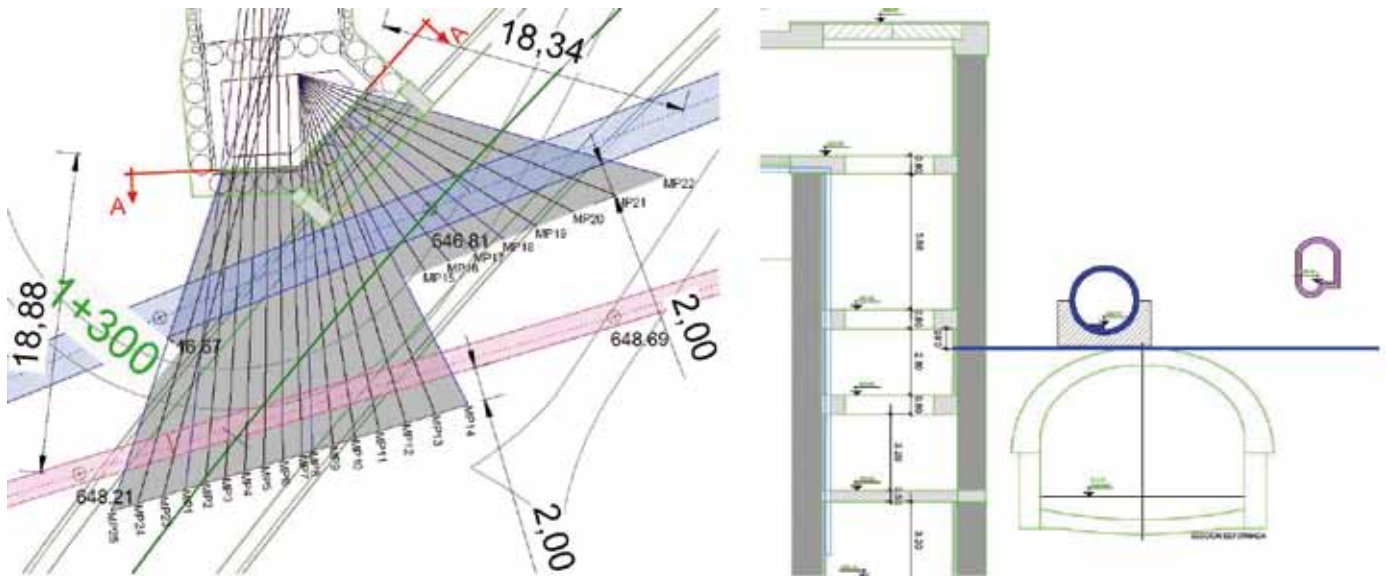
Planta y sección tipo del paraguas de micropilotes
